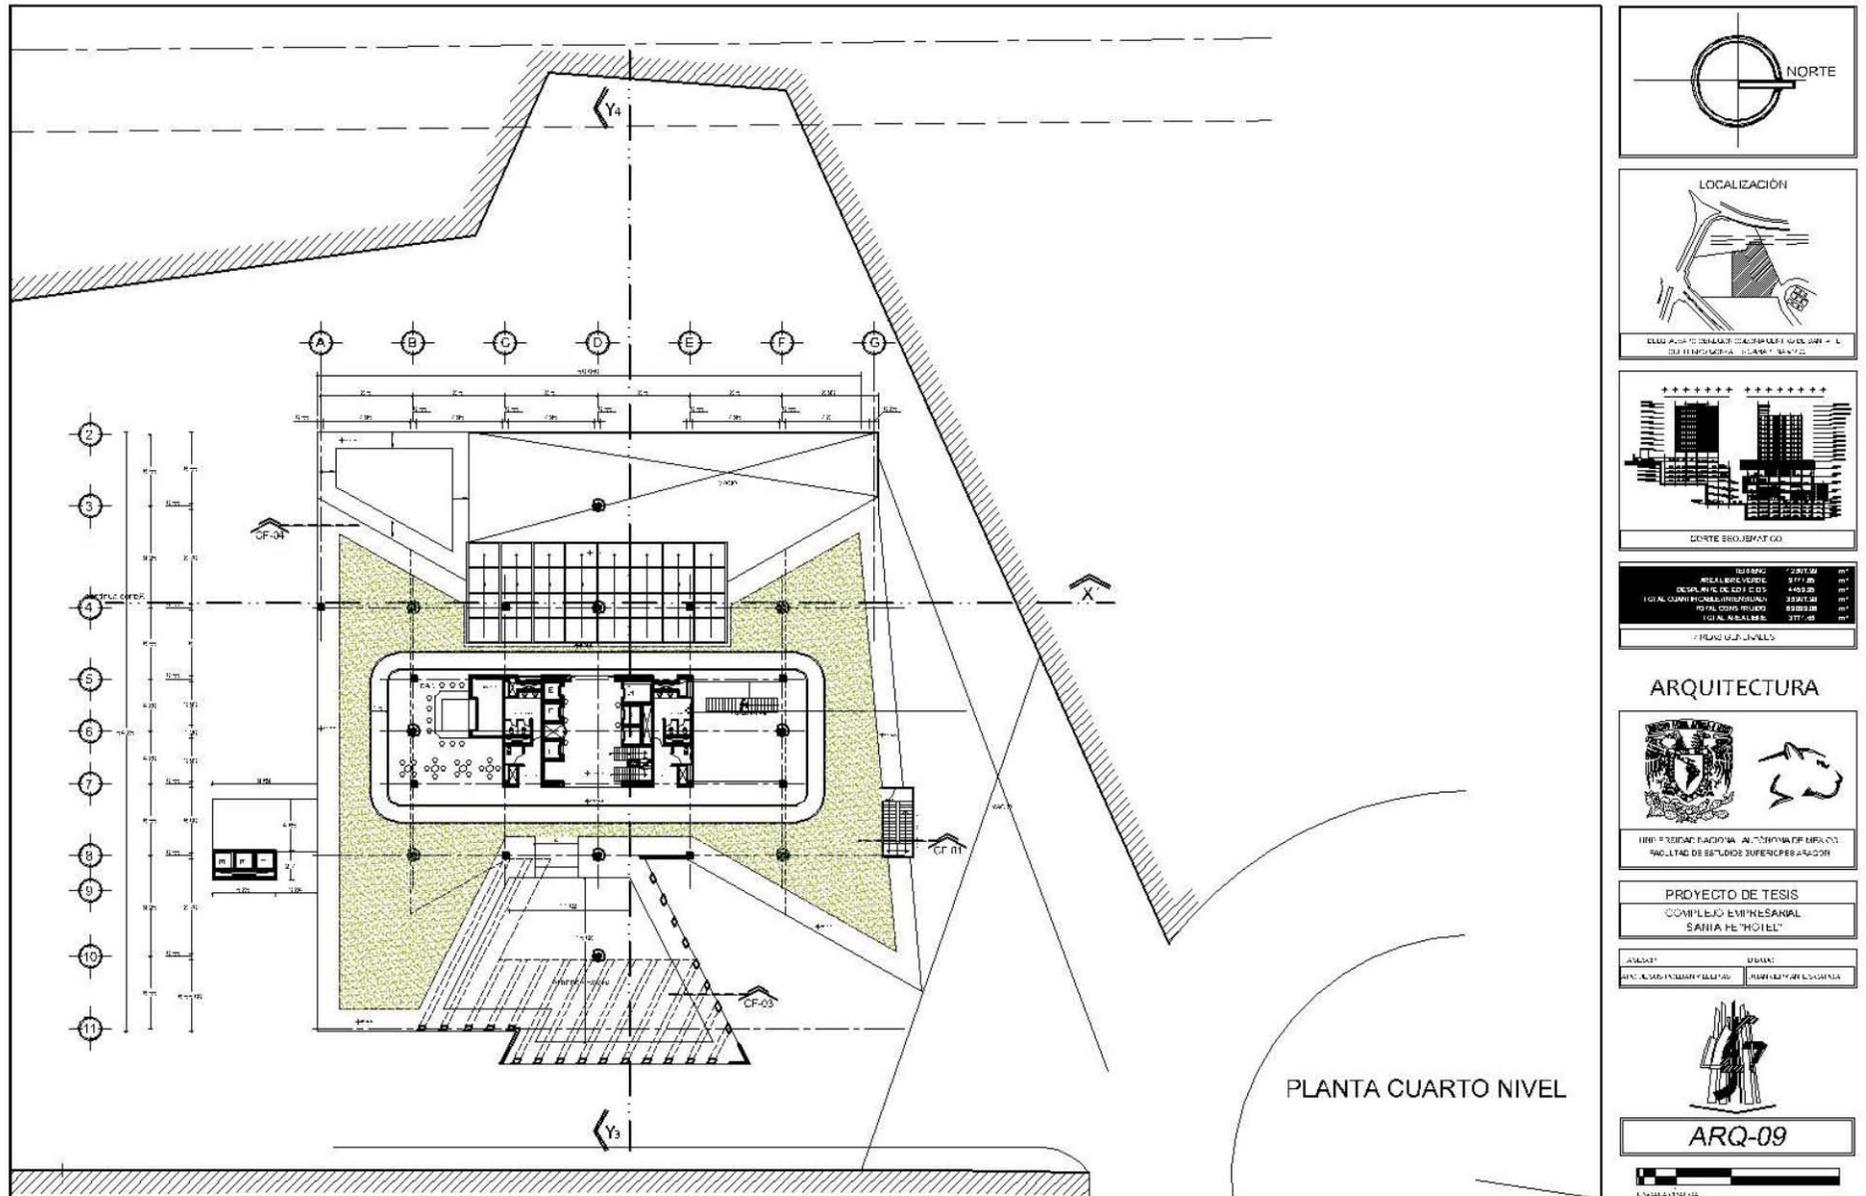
Plano ARQ-09; Planta Cuarto Nivel Hotel. Edición propia.
